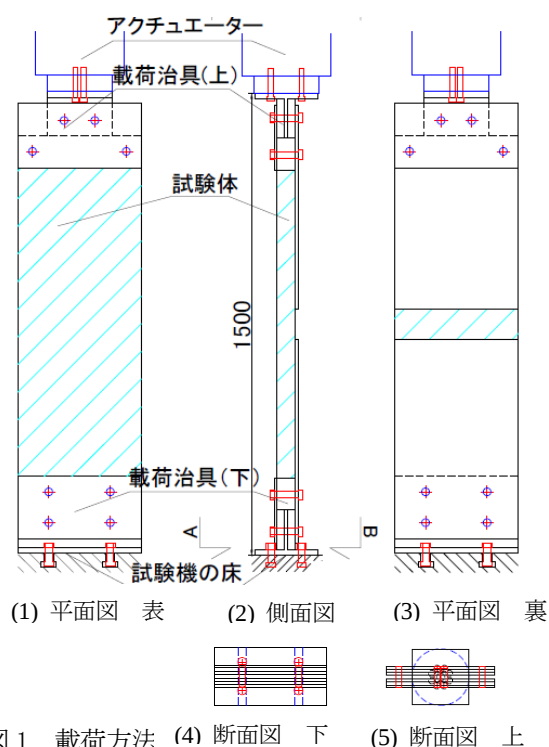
載荷方法 (4) 断面図 下 (5) 断面図 上
